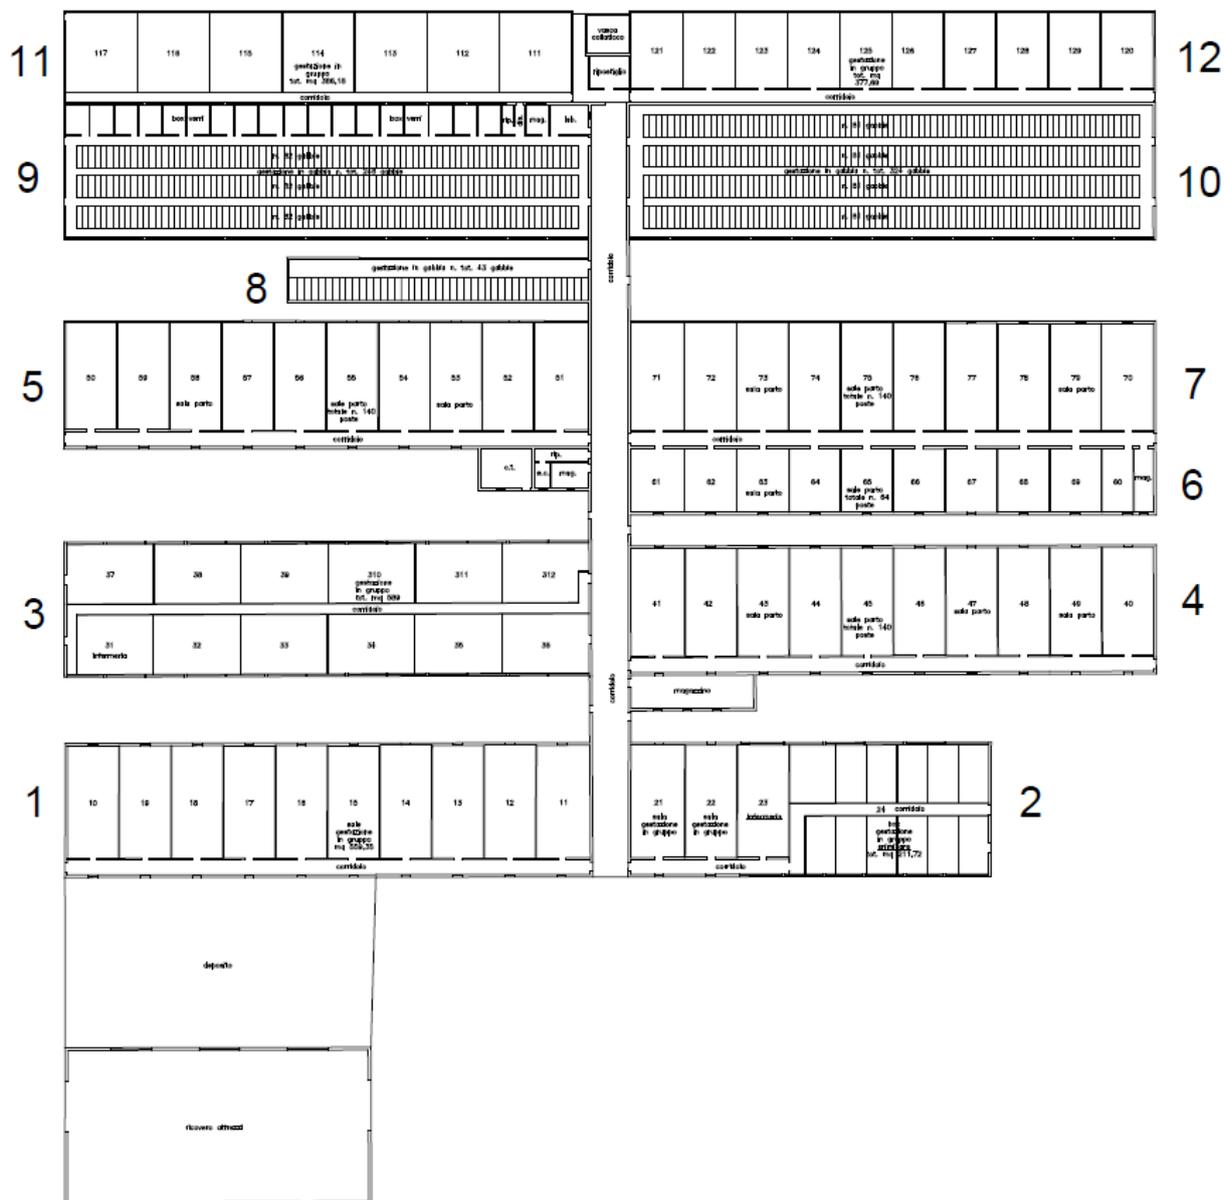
Planimetria dello stato di progetto dei fabbricati (Fonte: AIA 2020)
